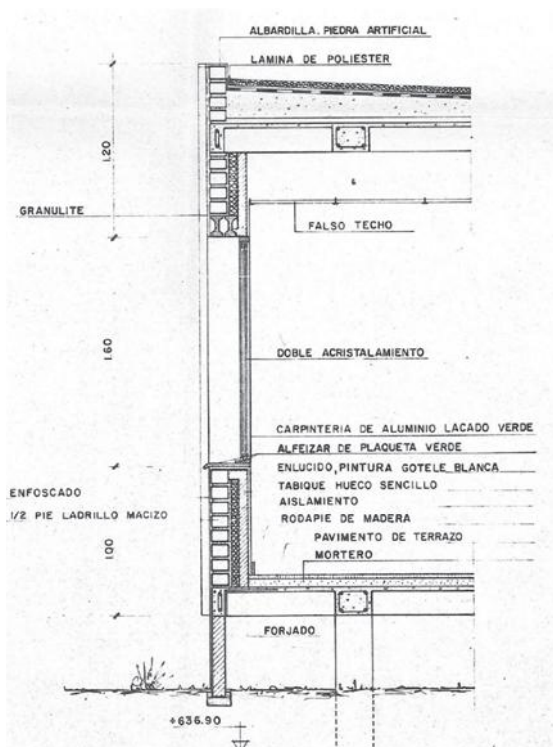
sección constructiva proyectada para el cerramiento exterior.
